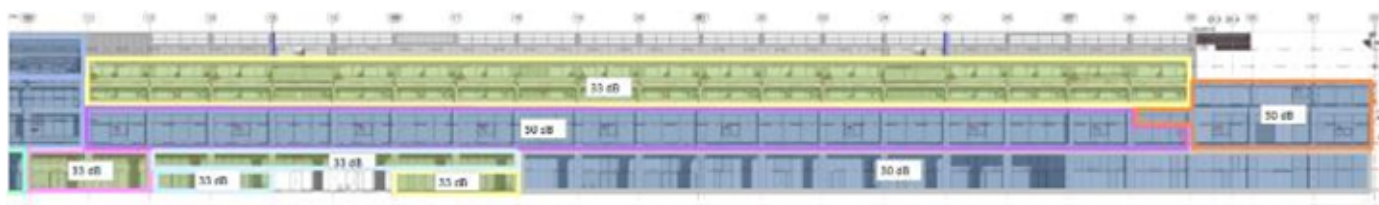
Objectif d'isolement de la façade Sud et façade Est
